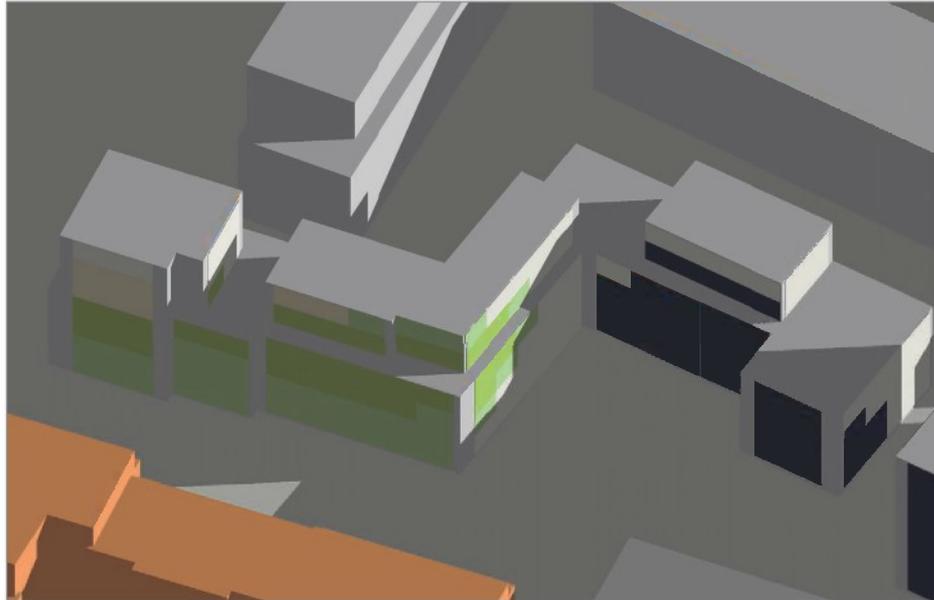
Veränderungen der Entwurfsvariante im Vergleich zur Planrechtsvariante - Gebäude 1
